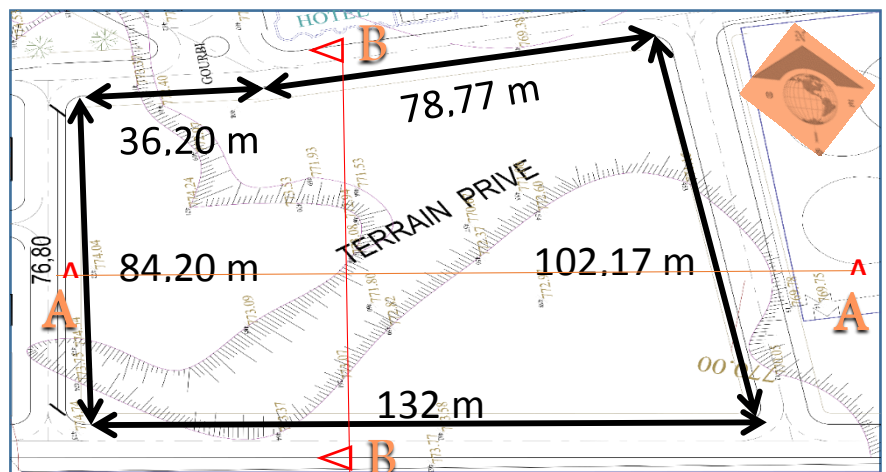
Plan de masse de site Source : Pose el Merdja
